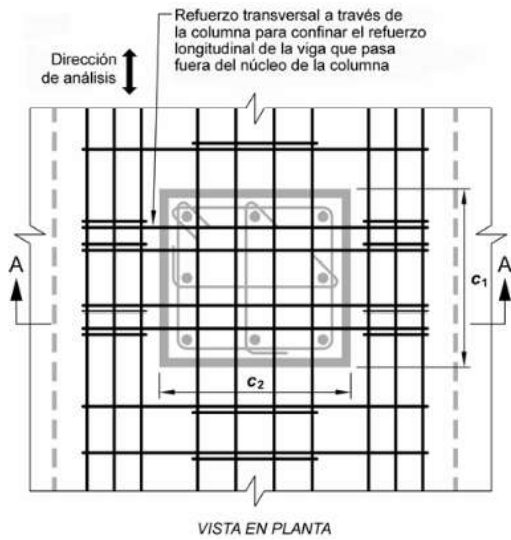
Máximo ancho efectivo de una viga ancha y refuerzo transversal requerido
